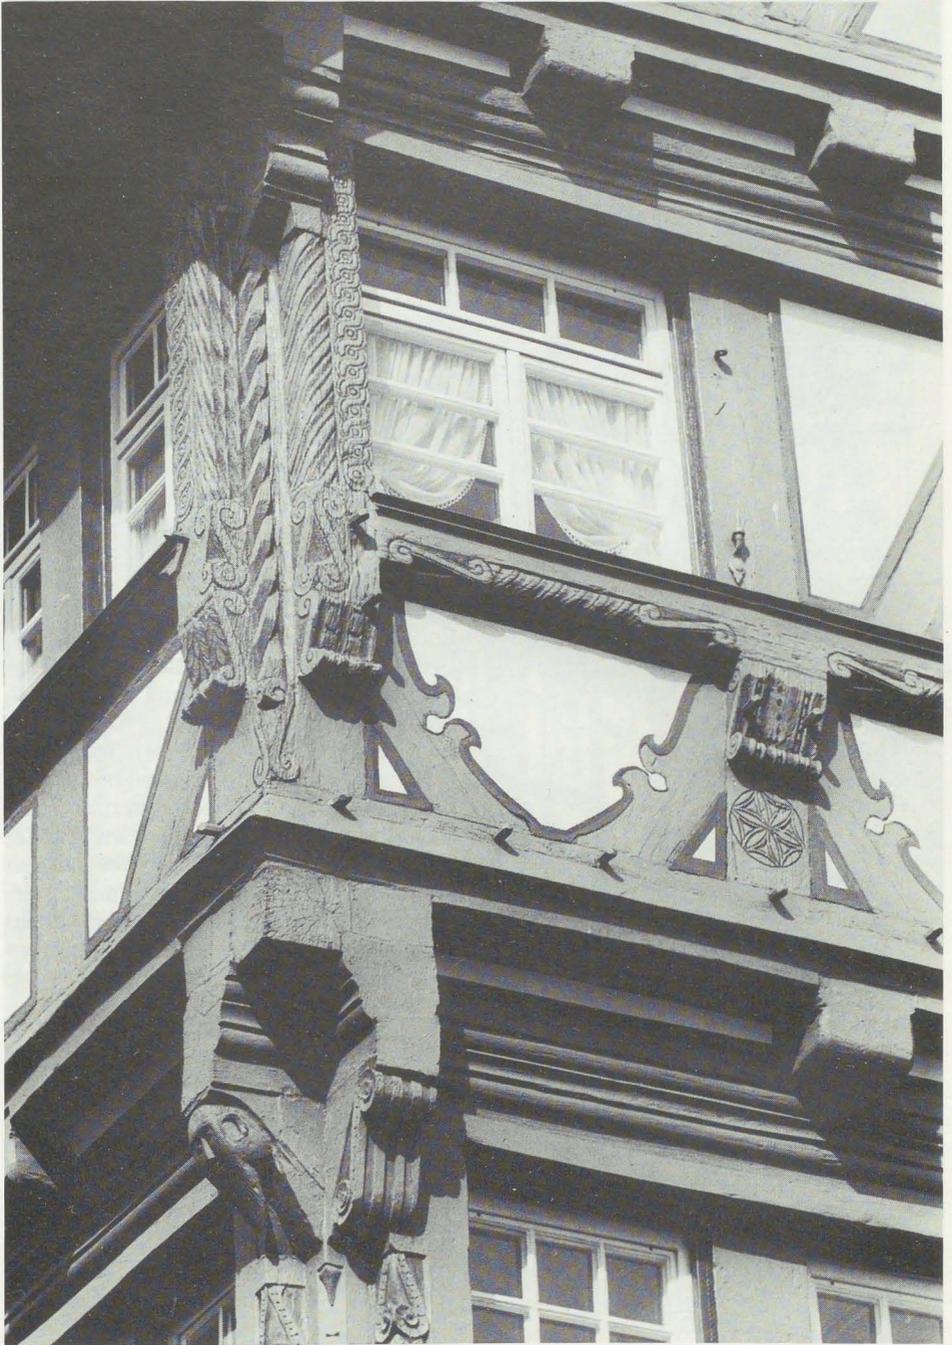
Baumann'sches Haus, Kirchgasse 31
